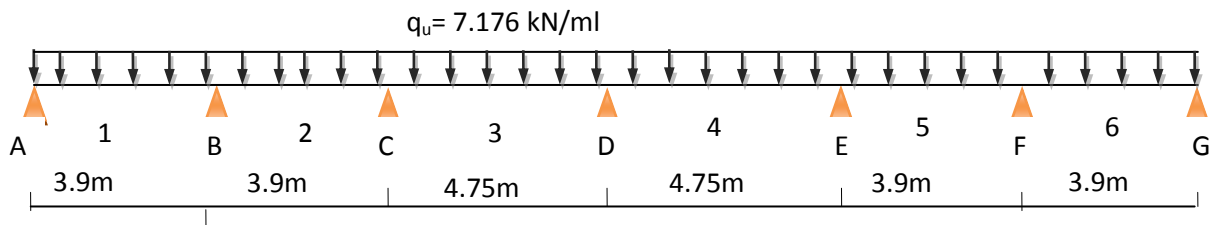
Schéma statique de la poutre continue reposant sur 7 appuis.
